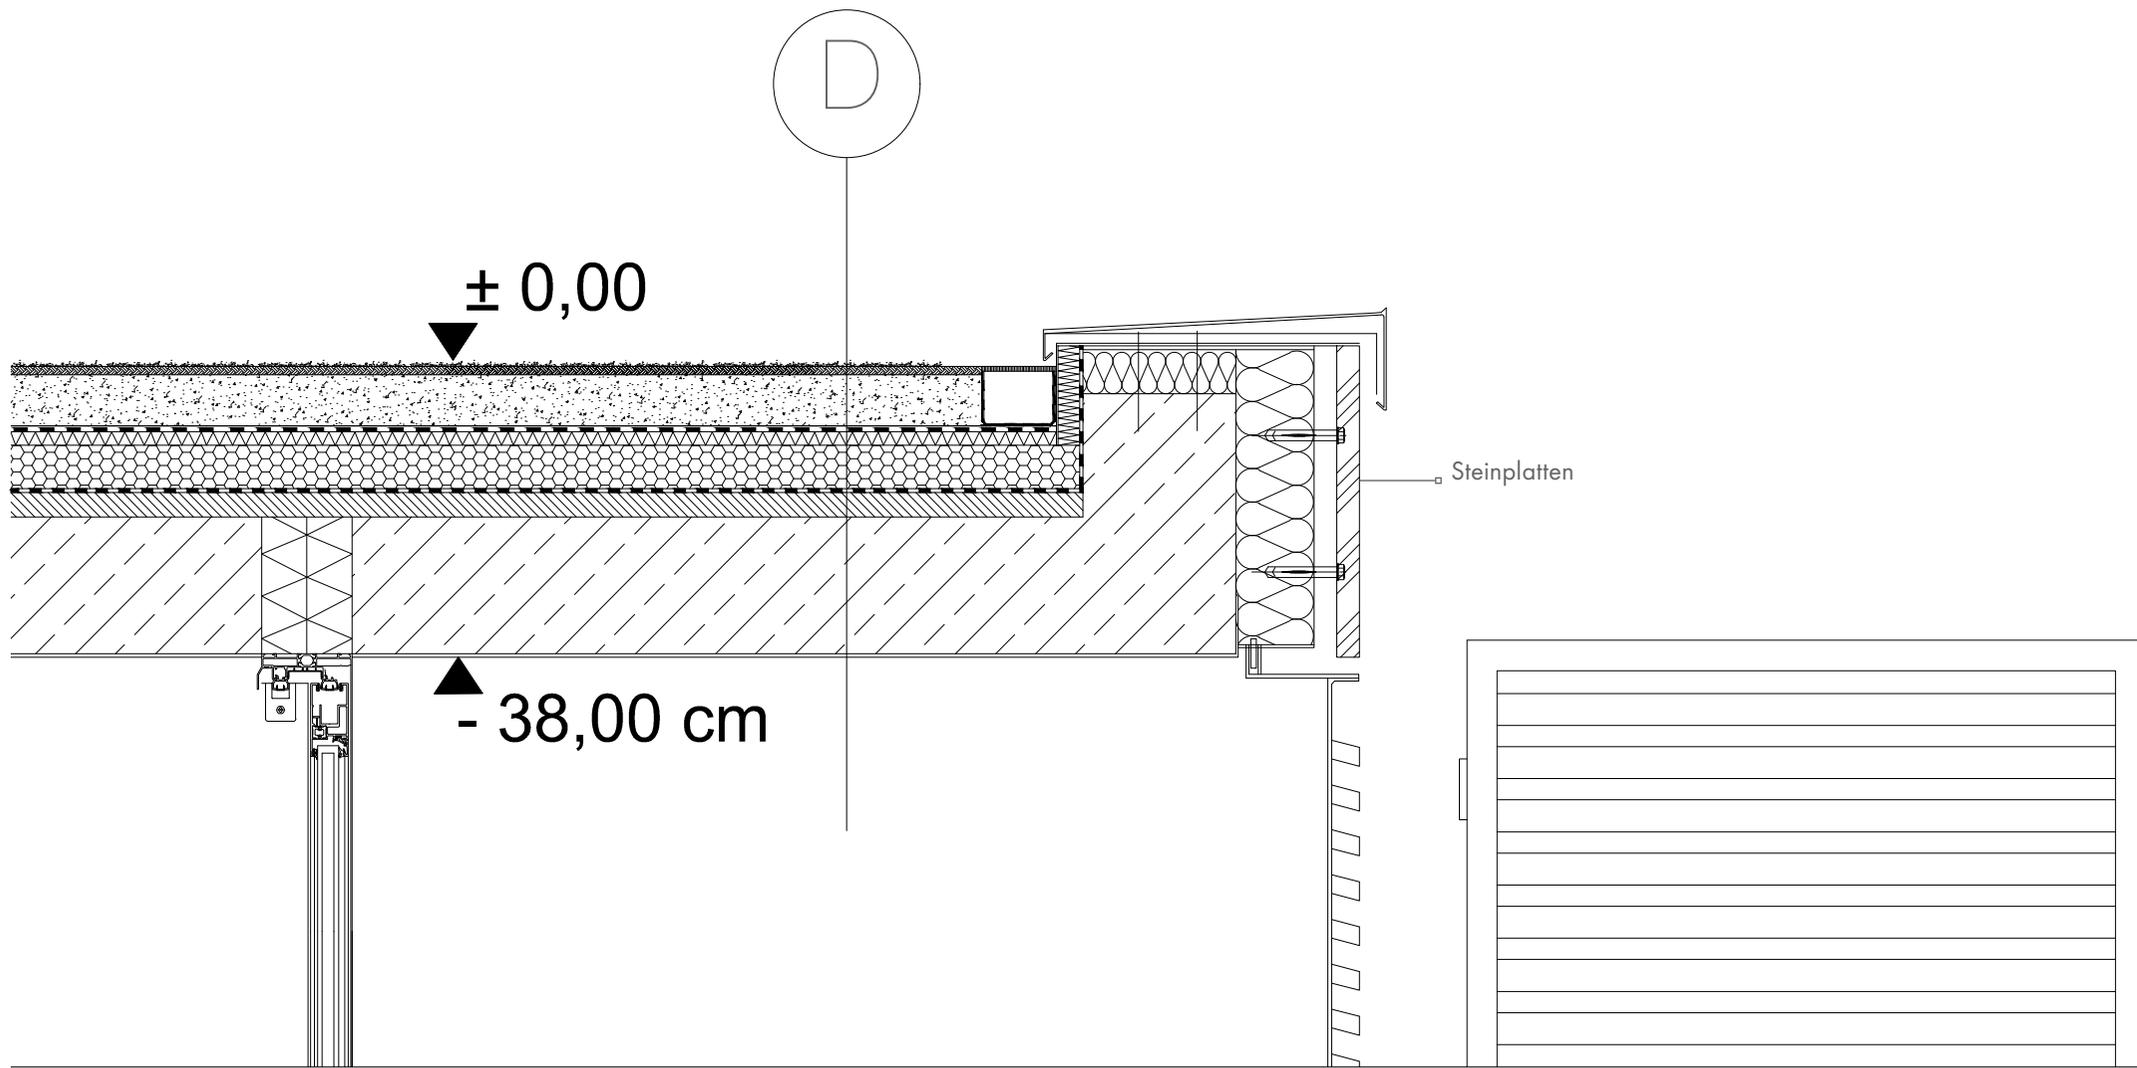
## DETAIL BODENAUFBAU, HOTELZIMMER 1:10
